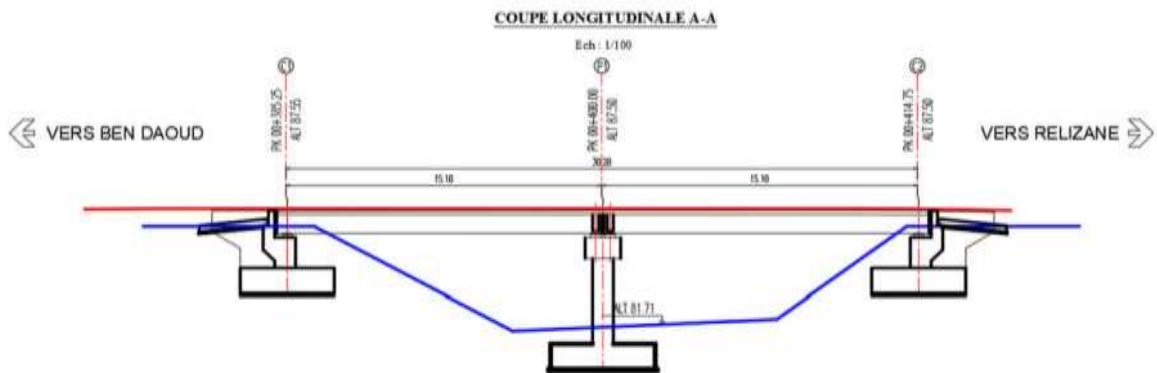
Coupe longitudinale A-A de la Variante de Poutre en Béton Armé
